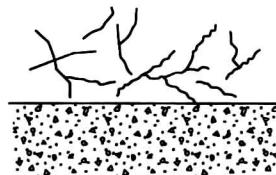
水泥安定性不合格或混凝土搅拌、运输时间过长产生的裂缝
